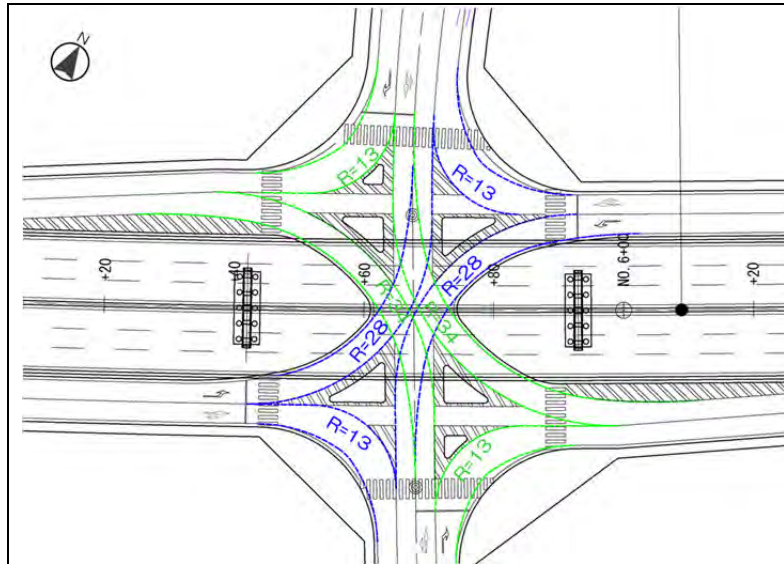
Carrefour Riviera 3 Plan de masse du côté ouest (demande de l'AGEROUTE)
